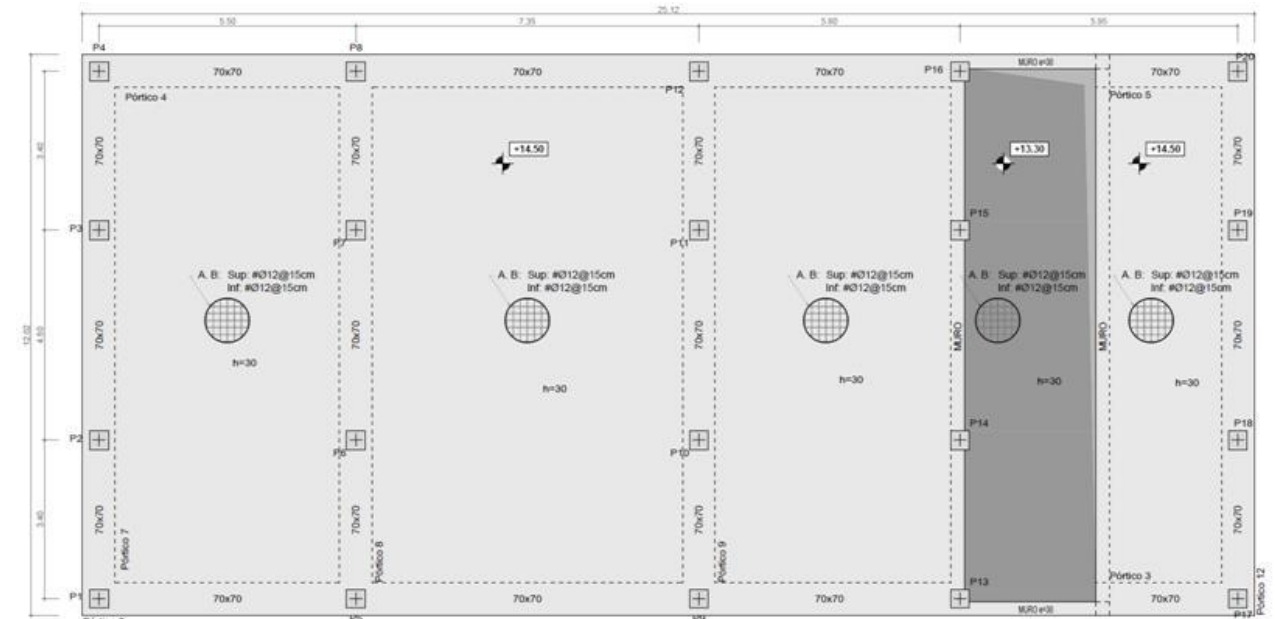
Losa de cimentación y zunchos de recrido bajo alineación de pilares
